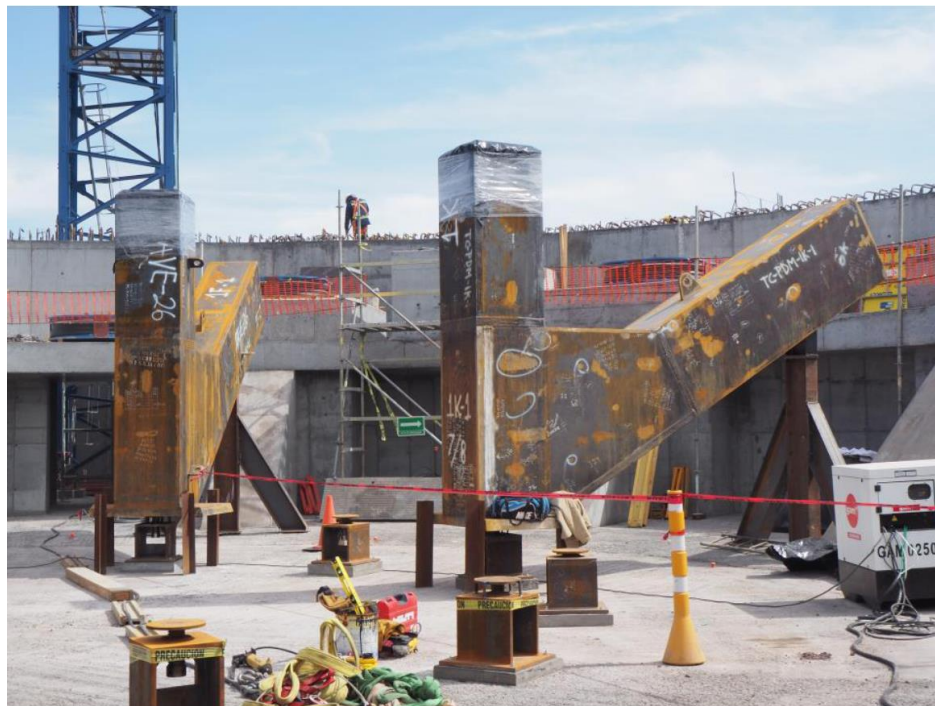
Vista del proceso de armado de la armadura de transferencia.
